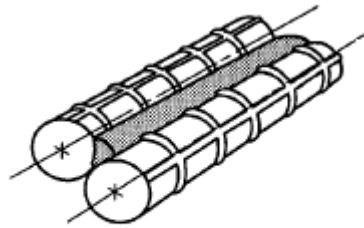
Vista transversal del cordón de soldadura de la junta a solape
